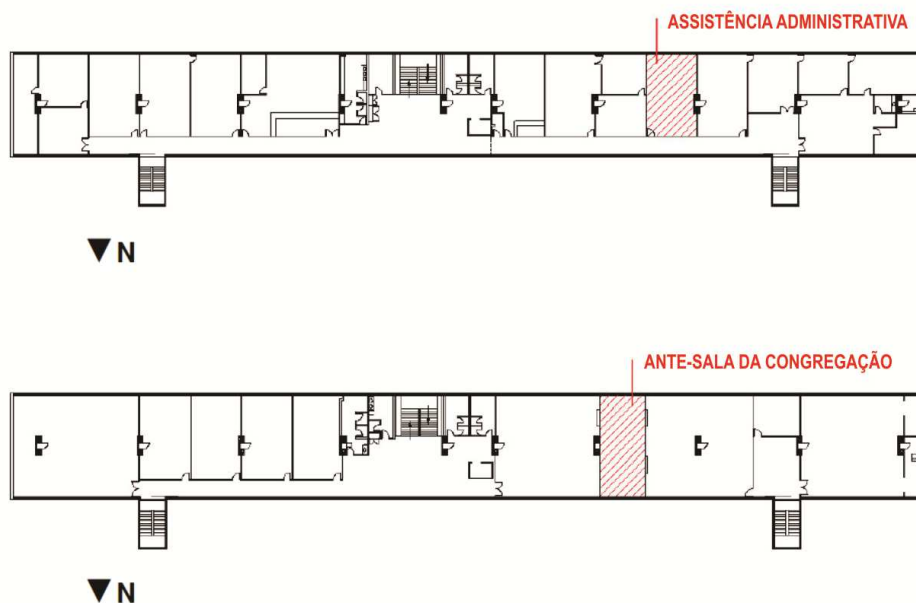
Planta do 1º e 3º Pavimento - Bloco E1
